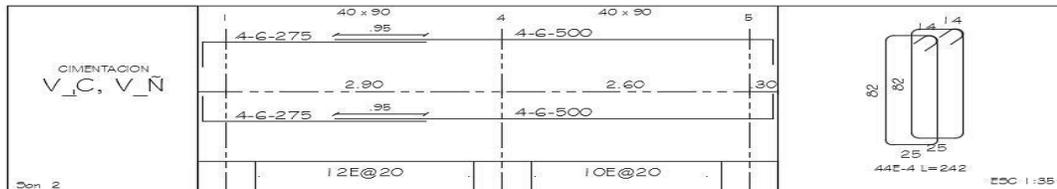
Despiece de viga de cimentación sentido longitudinal.
